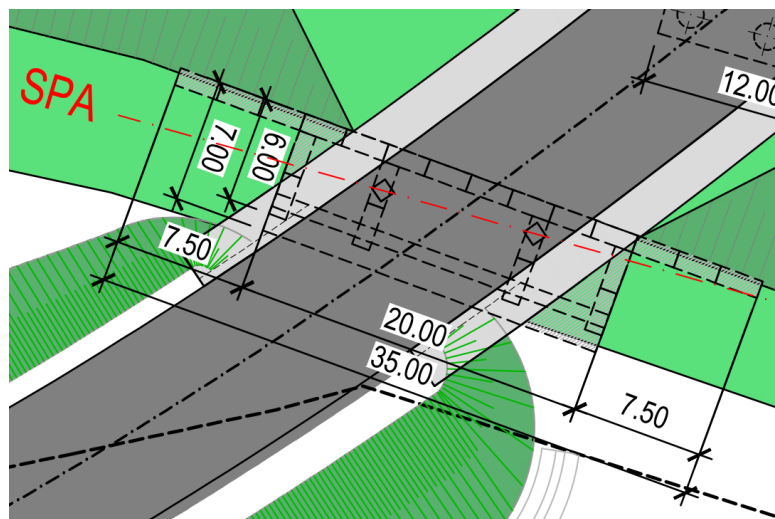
Casseratura spalla – Vista in pianta
